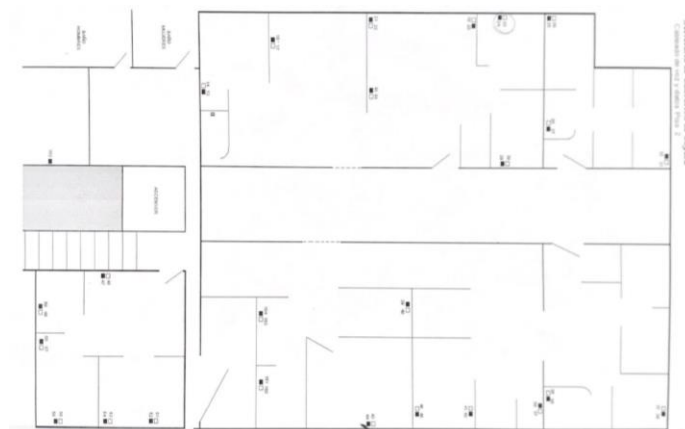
Planos Piso 2 Puntos de Red y Telefonía.
